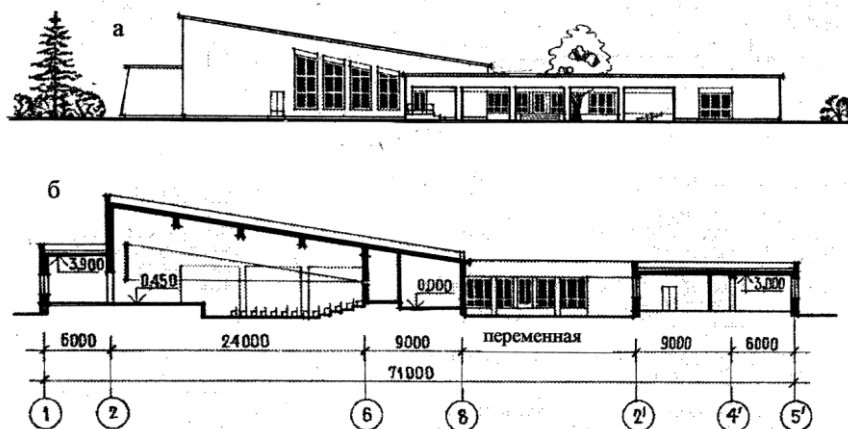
Пример выполнения чертежей здания клуба: а – фасад; б – разрез
